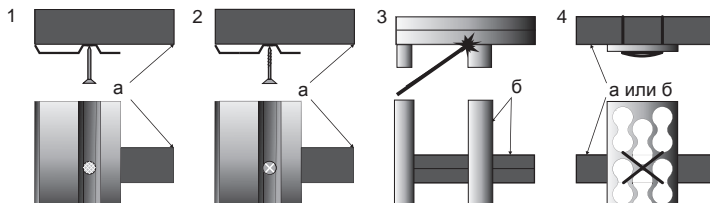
Способы крепления деталей глухой и легкой оград к деревянным (а) и металлическим (б) прожилинам: 1 — гвоздем; 2 — саморезом; 3 — сваркой; 4 — проволокой
